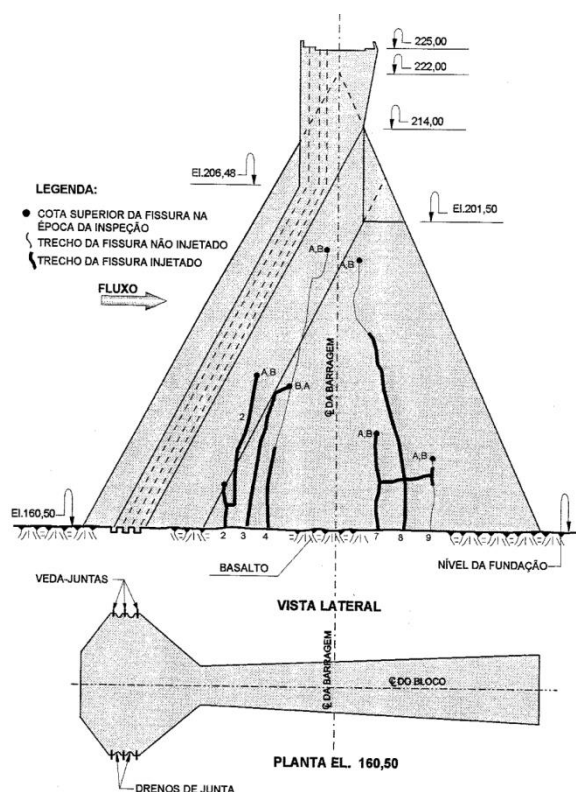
Localização das fissuras num bloco de contraforte típico – Fonte: BETIOLI *et al.*[33]
